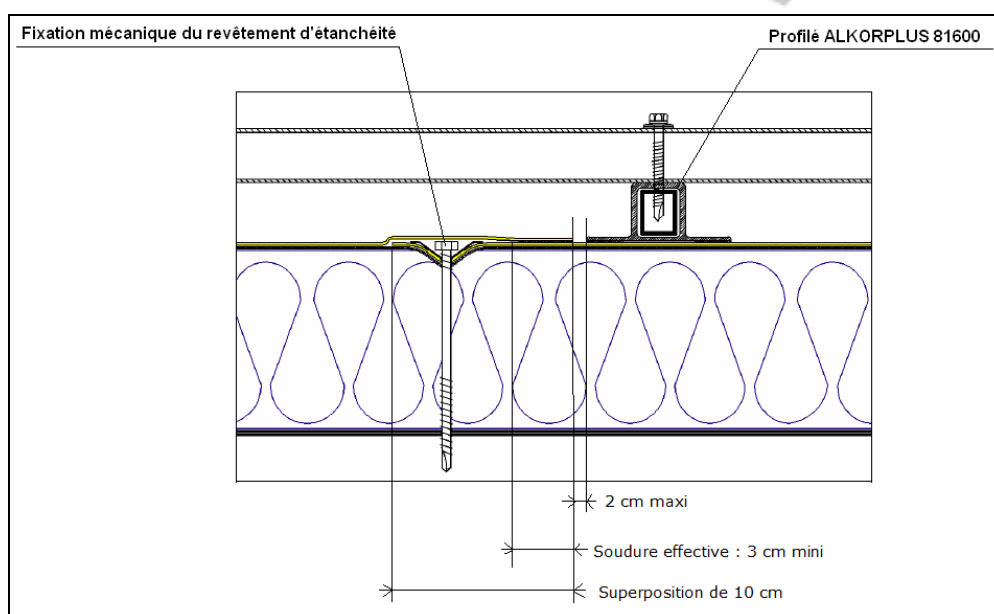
Positionnement du profilé ALKORPLAN 81600 par rapport à la fixation mécanique du revêtement d'étanchéité
